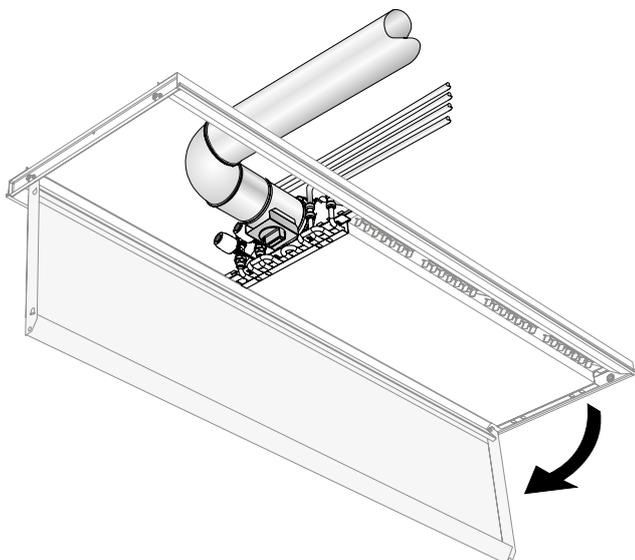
Exemple d'accessibilité via façade du module de parement (raccordement latéral horizontal).
